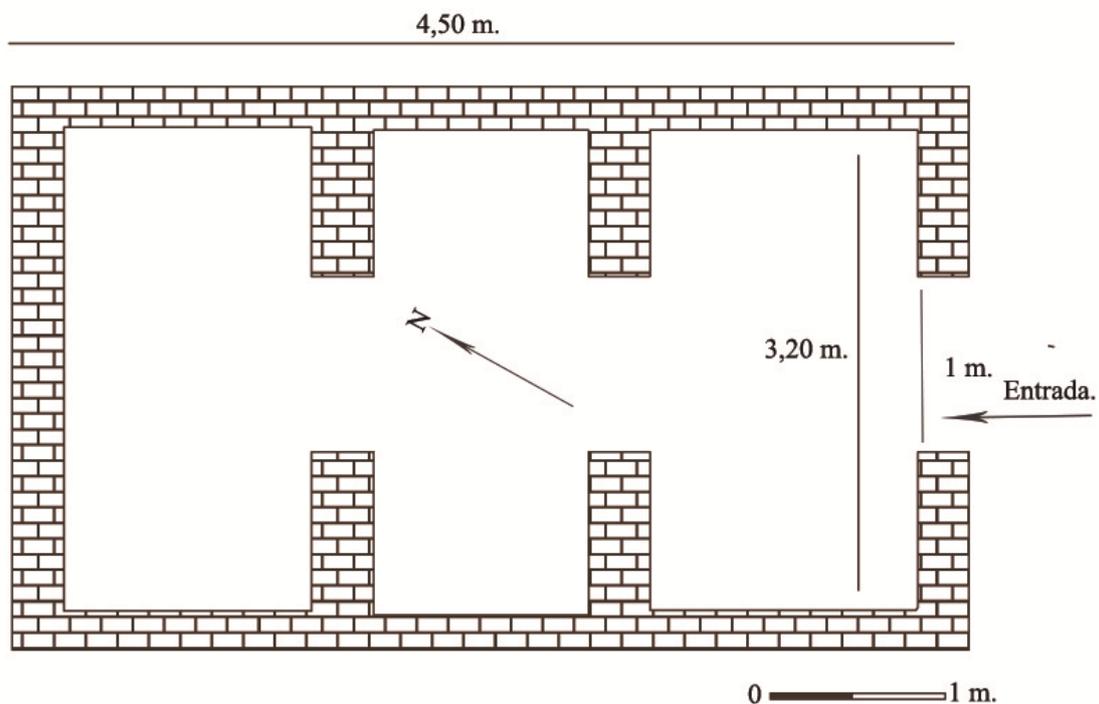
Planta de aljibe. La técnica constructiva, mampostería concertada con refuerzo de sillarejos. (Elaboración propia).
